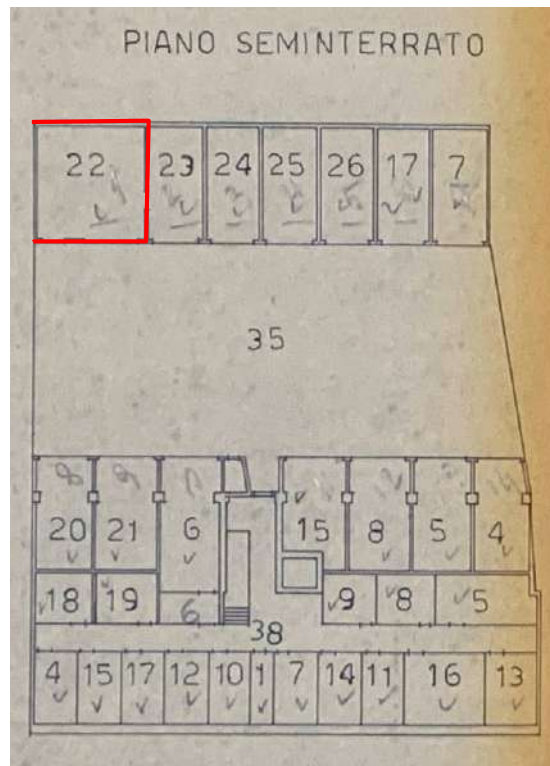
Estratto tavola accatastamento lotto 7° allegato alla Autorizzazione Edilizia Prot. 3748 del 31.08.1960
